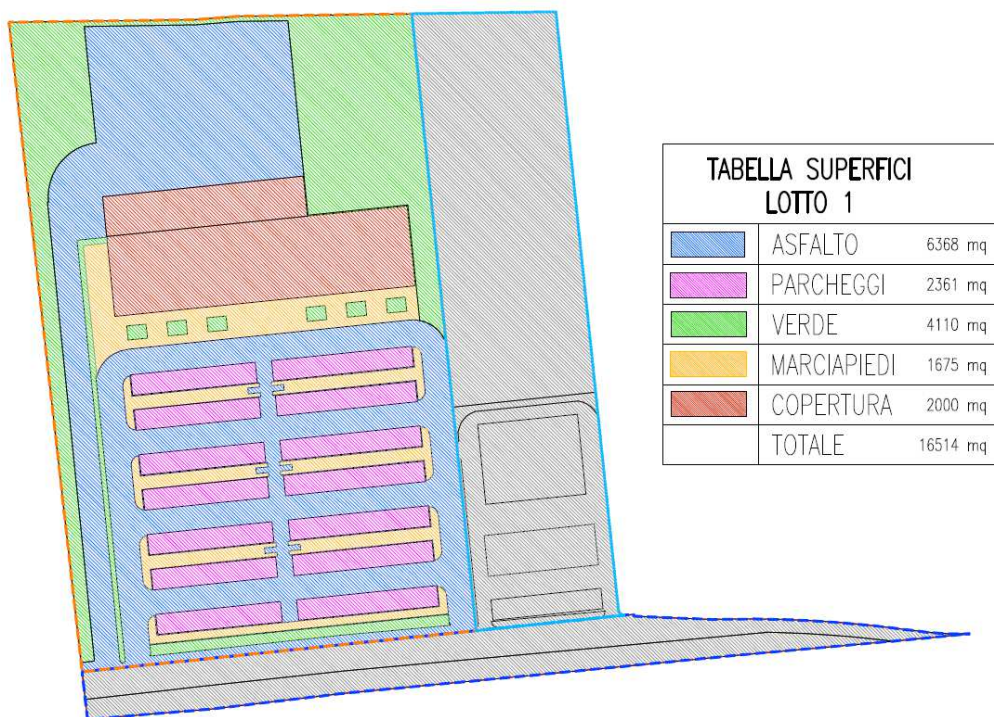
SUDDIVISIONE DELLE DESTINAZIONE D'USO ALLO STATO DI PROGETTO – LOTTO 1
